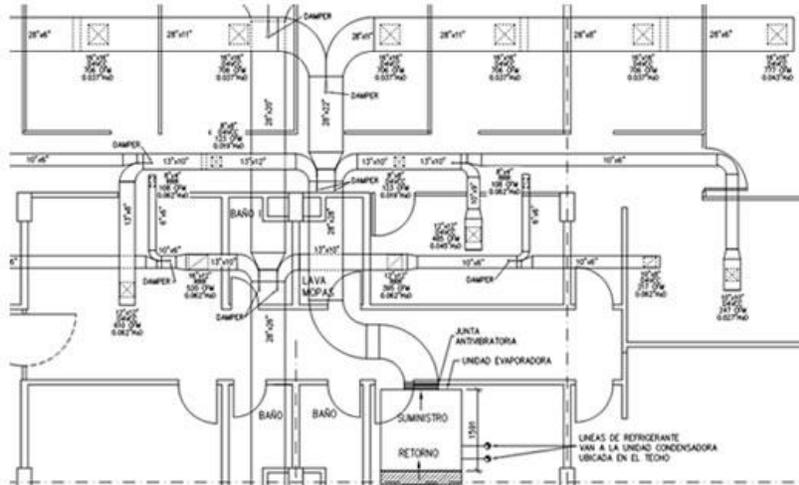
Ejemplo de plano de disposiciones generales. Fuente: planos-industriales.blogspot
